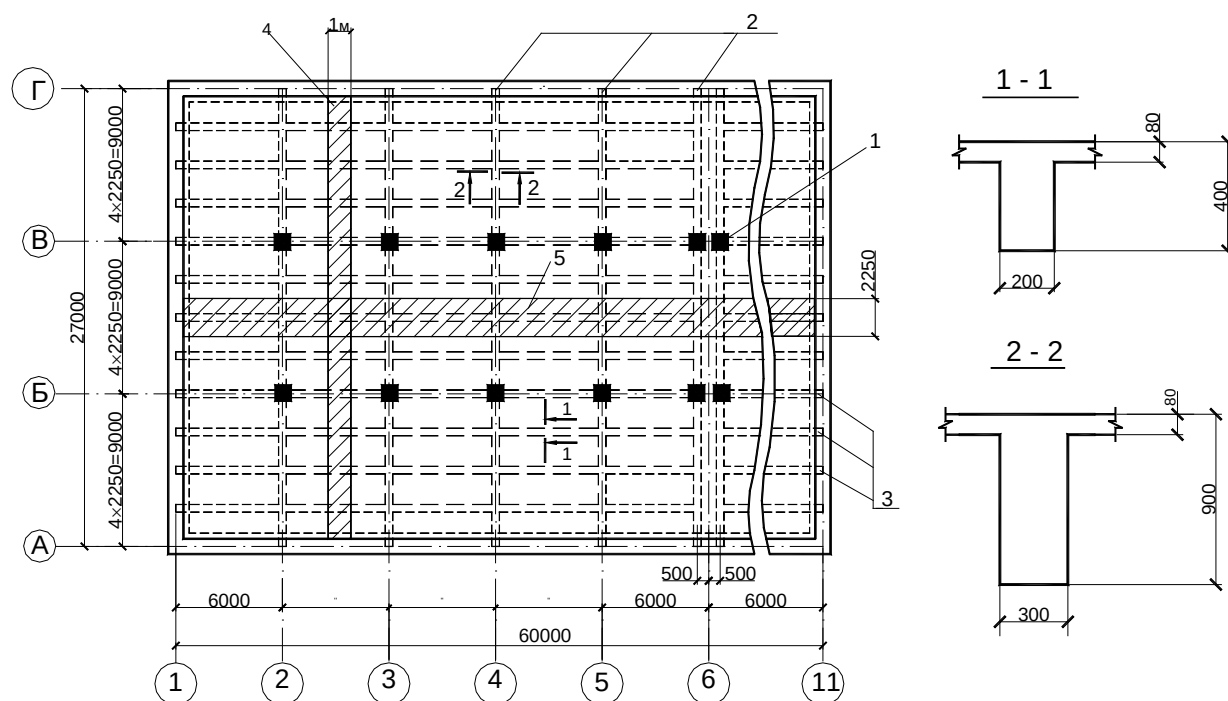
Конструктивная схема монолитного ребристого перекрытия с балочными плитами: 1 - промежуточные колонны; 2 - главные балки; 3 - второстепенные балки; 4 - расчетная полоса плиты; 5 - грузовая полоса для второстепенной балки
